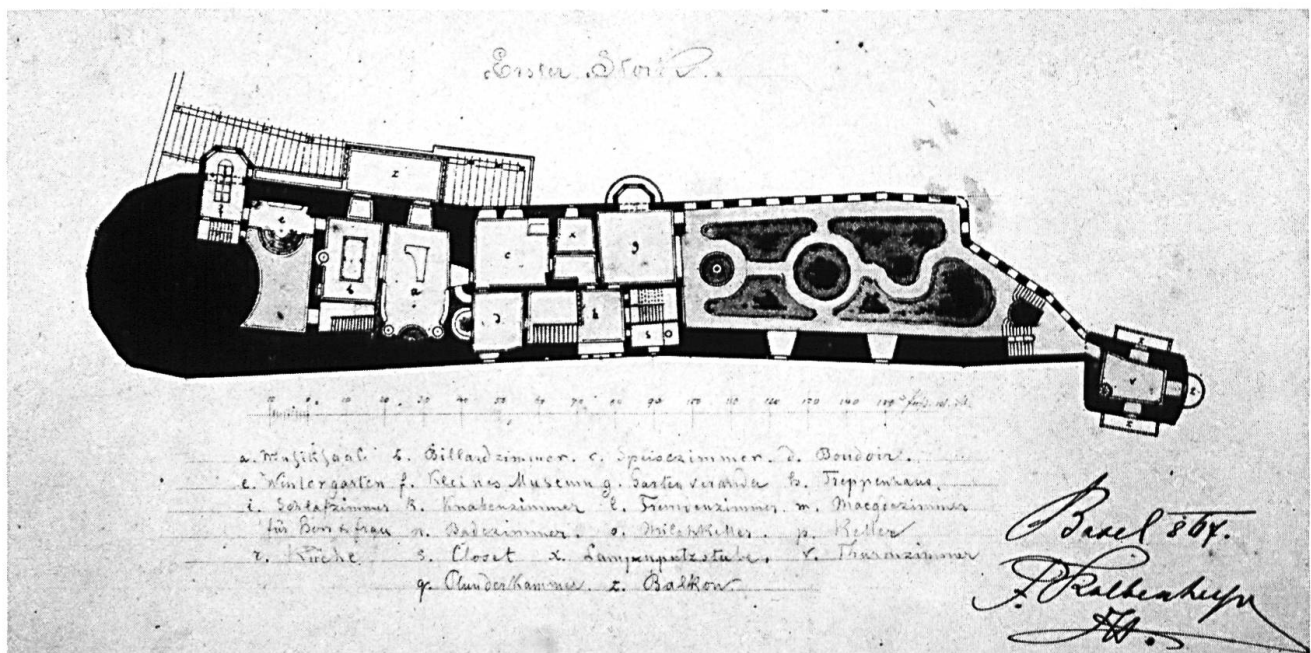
Oensingen, Schloss Neu-Bechburg. Grundriss Kolbenheyers von 1867 (vgl. Abb. 9). Grundriss des zum Piano nobile ausgestalteten ersten Obergeschosses: das Raumprogramm ist den grossbürgerlichen Ansprüchen der Bauherrschaft angepasst. (Staatsarchiv Solothurn).
